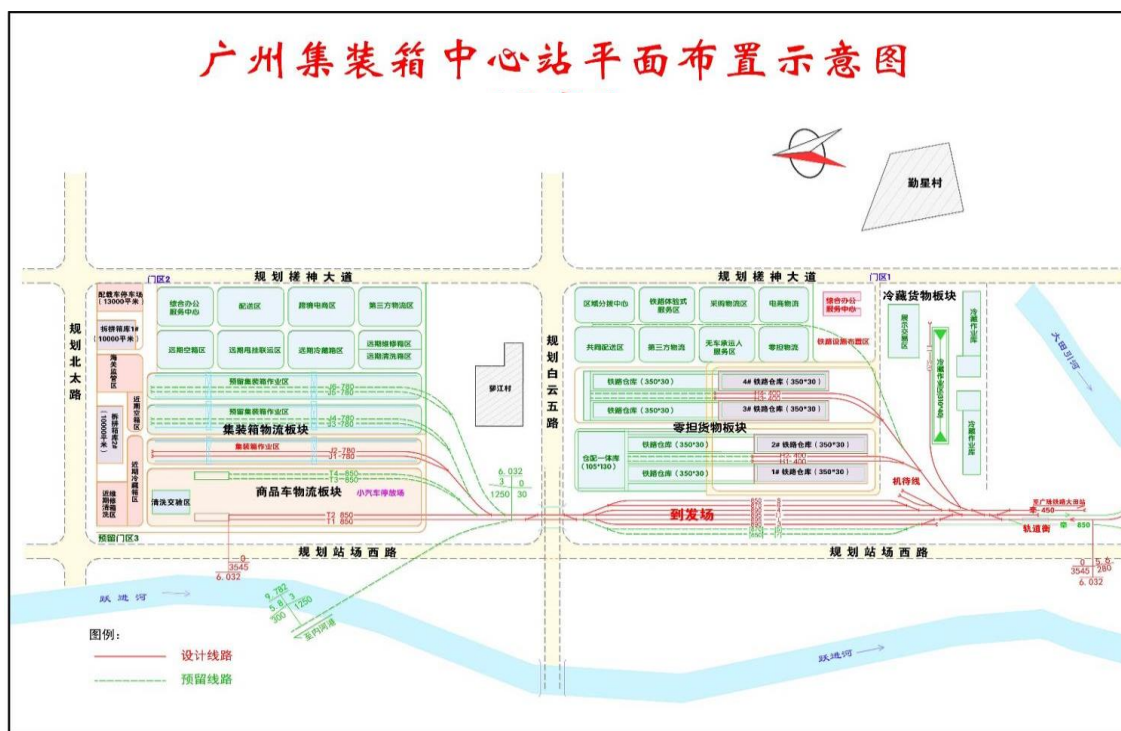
新建铁路广州集装箱中心站工程平面布置示意图
